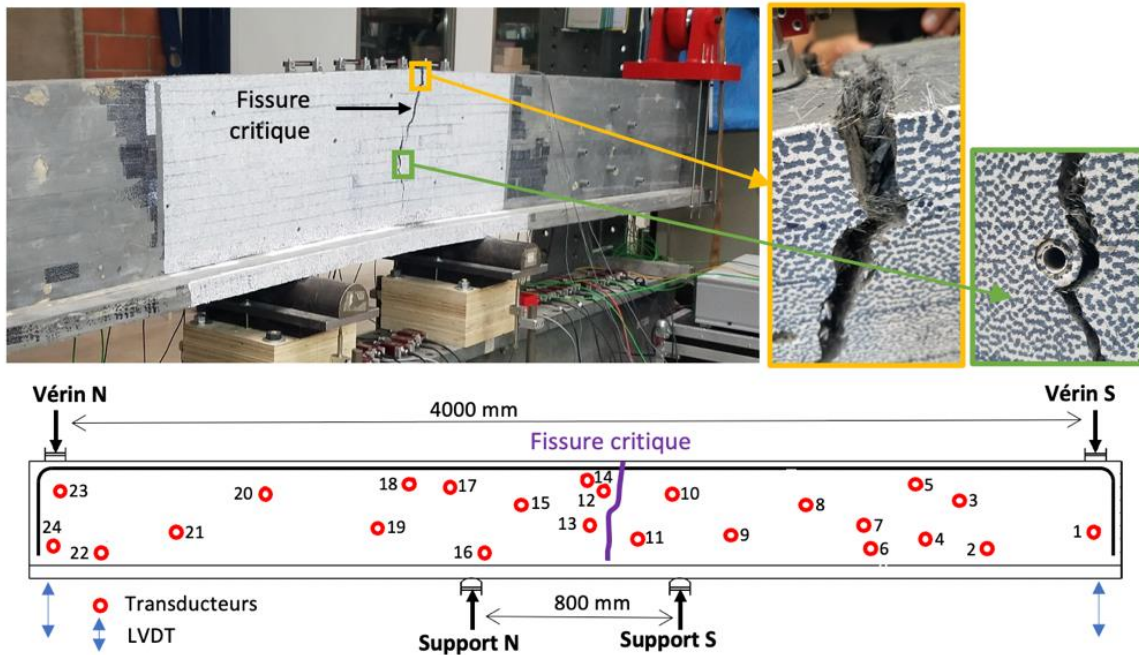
Photo de la fissure critique sur la poutre et emplacement lié au réseau de transducteurs.
